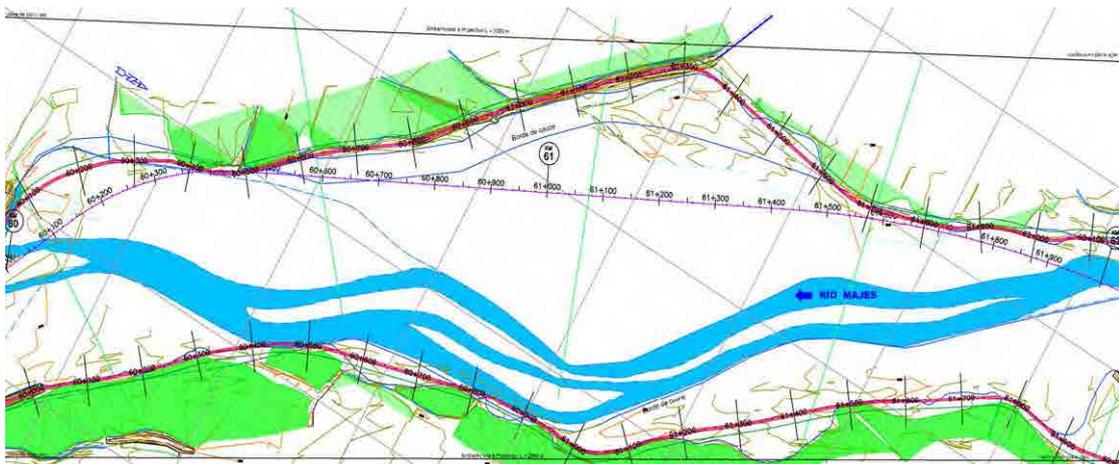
Planta de instalaciones Majes-6 (3)
